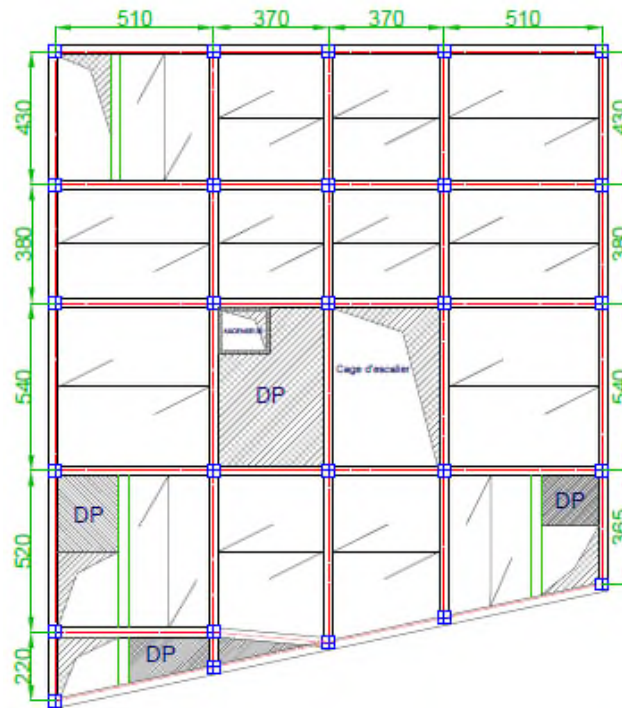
Disposition des poutrelles de l'étage 9-10.
